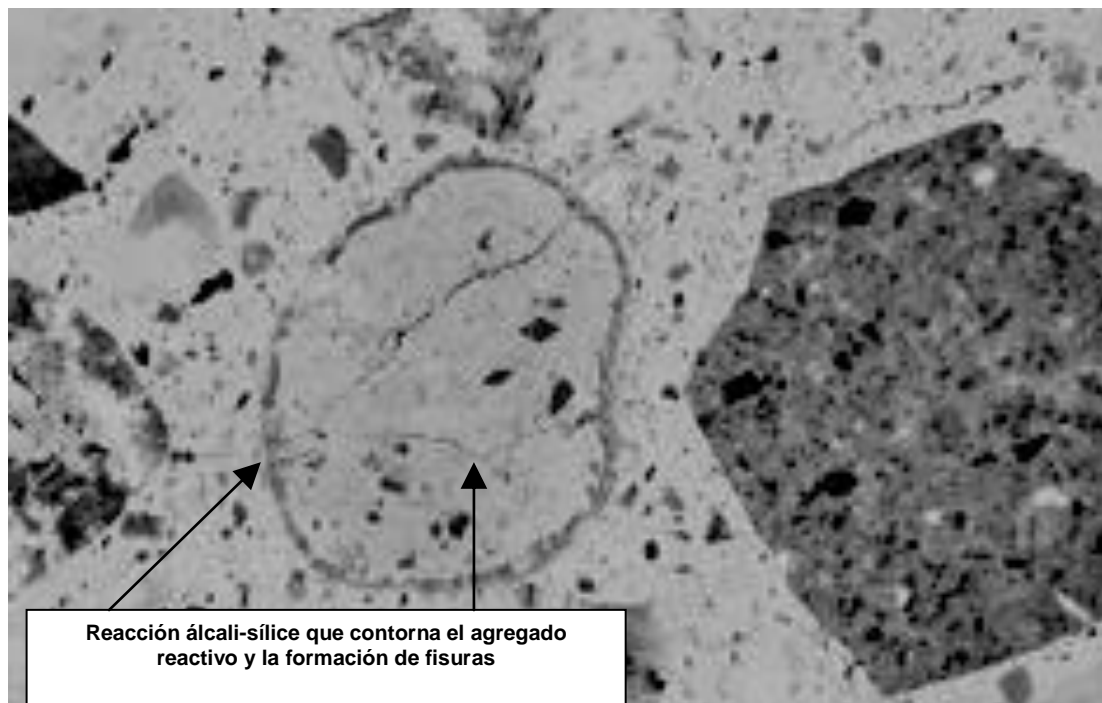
Agrietamiento en el concreto debido a la reacción álcali-sílice
